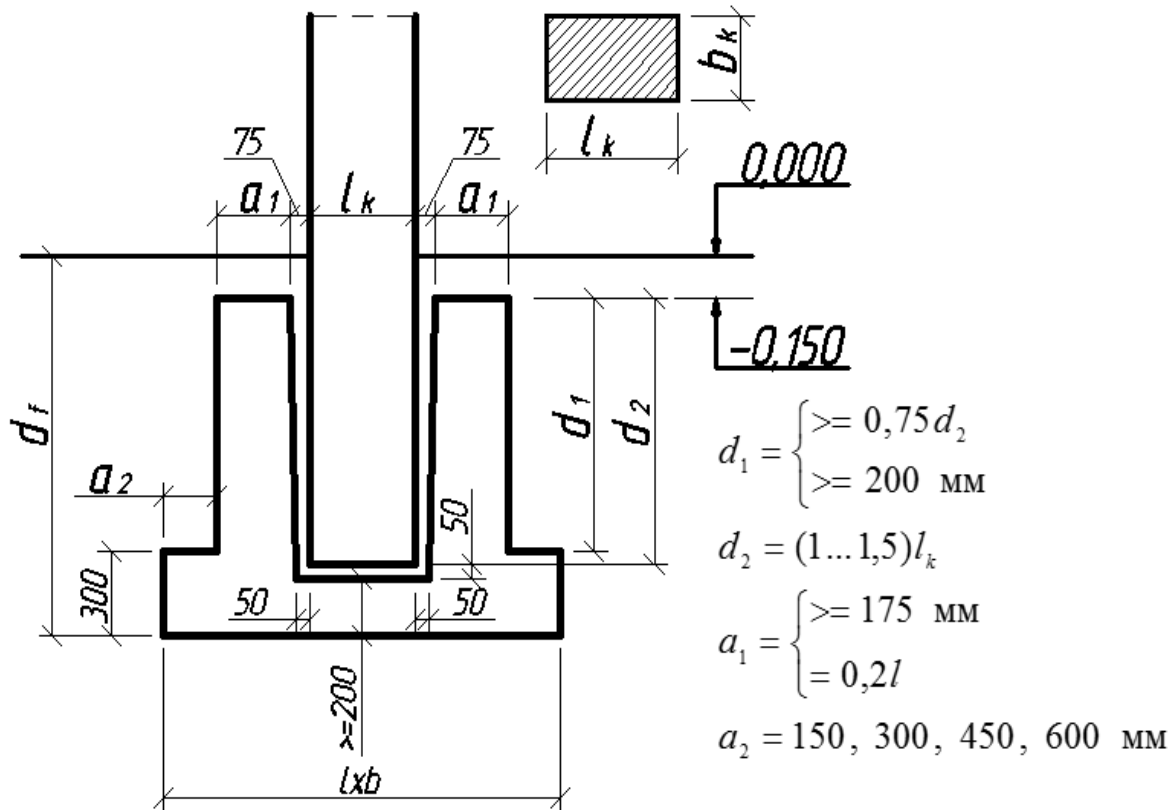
Схема к определению величины глубины заложения фундамента
